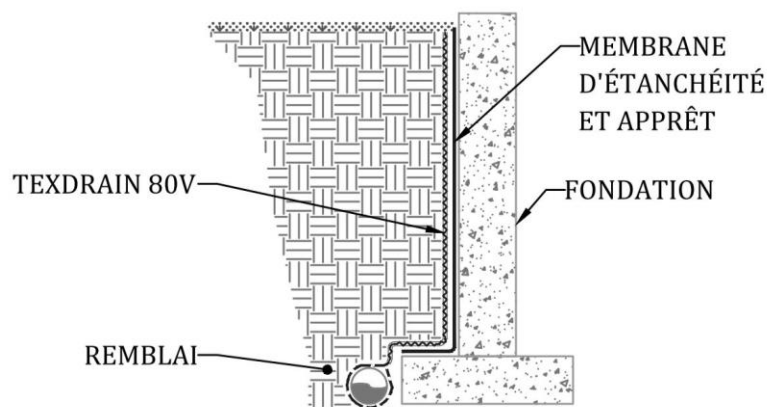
Coupe type du TEXDRAIN 80V, application pour les murs de fondation
